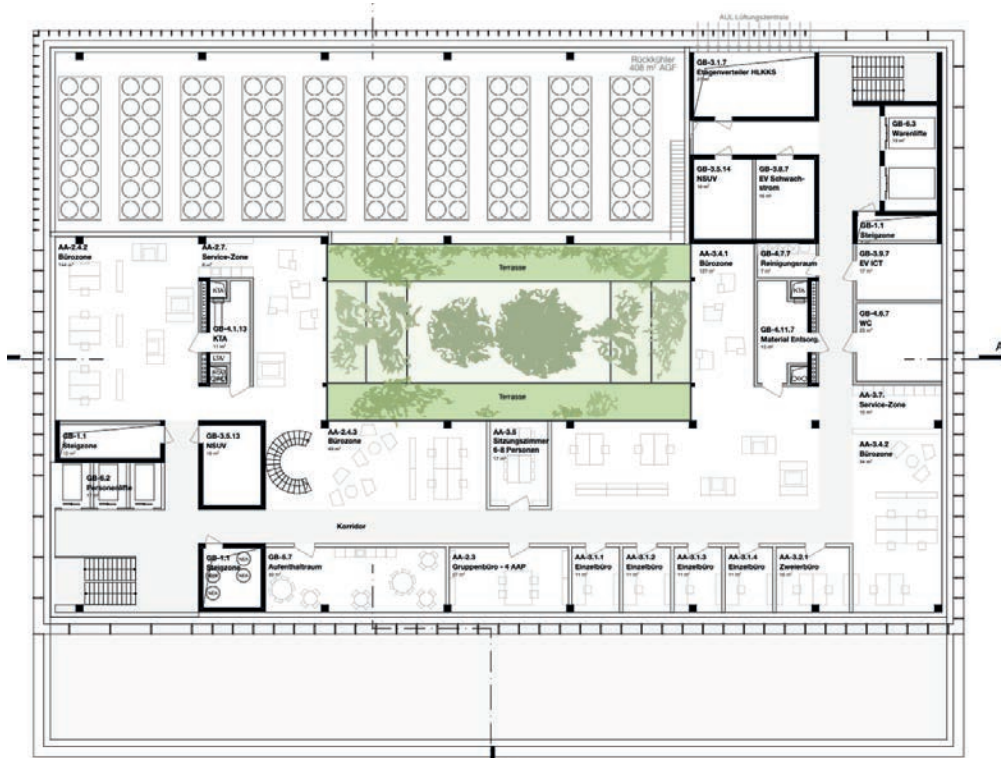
ARGE Silvia Gmür Reto Gmür Architekten: Grundriss 5. Obergeschoss
